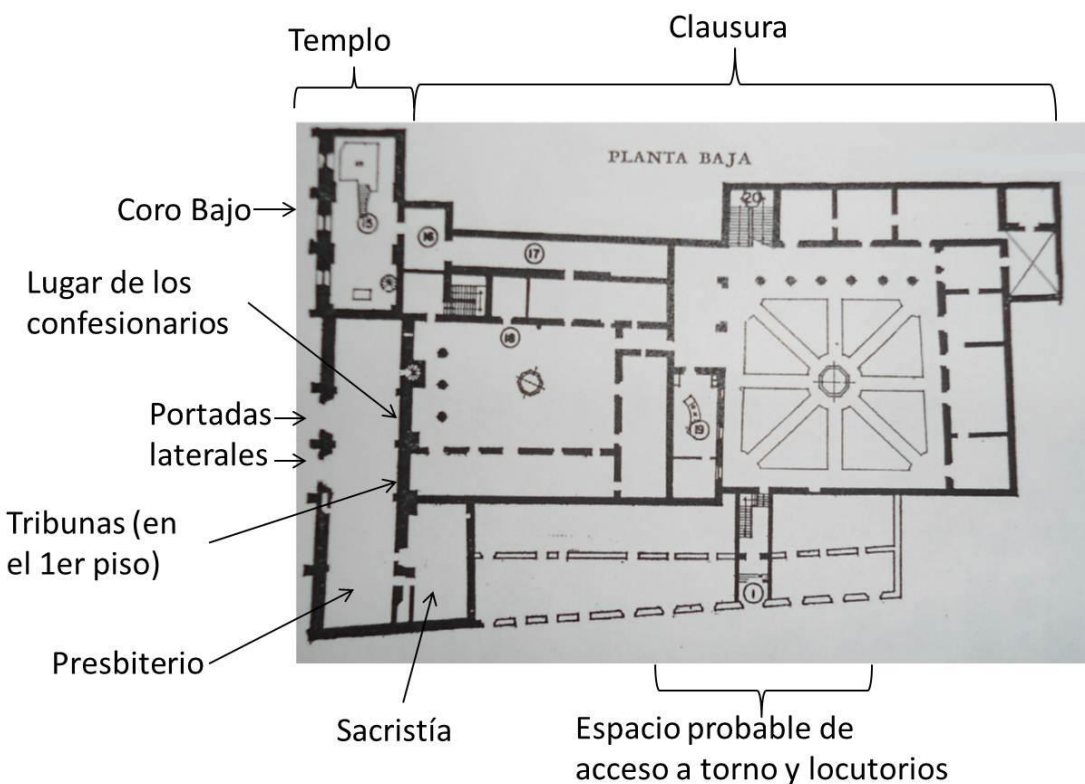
Templo. Planta baja de un conjunto conventual femenino del s. XVII.
